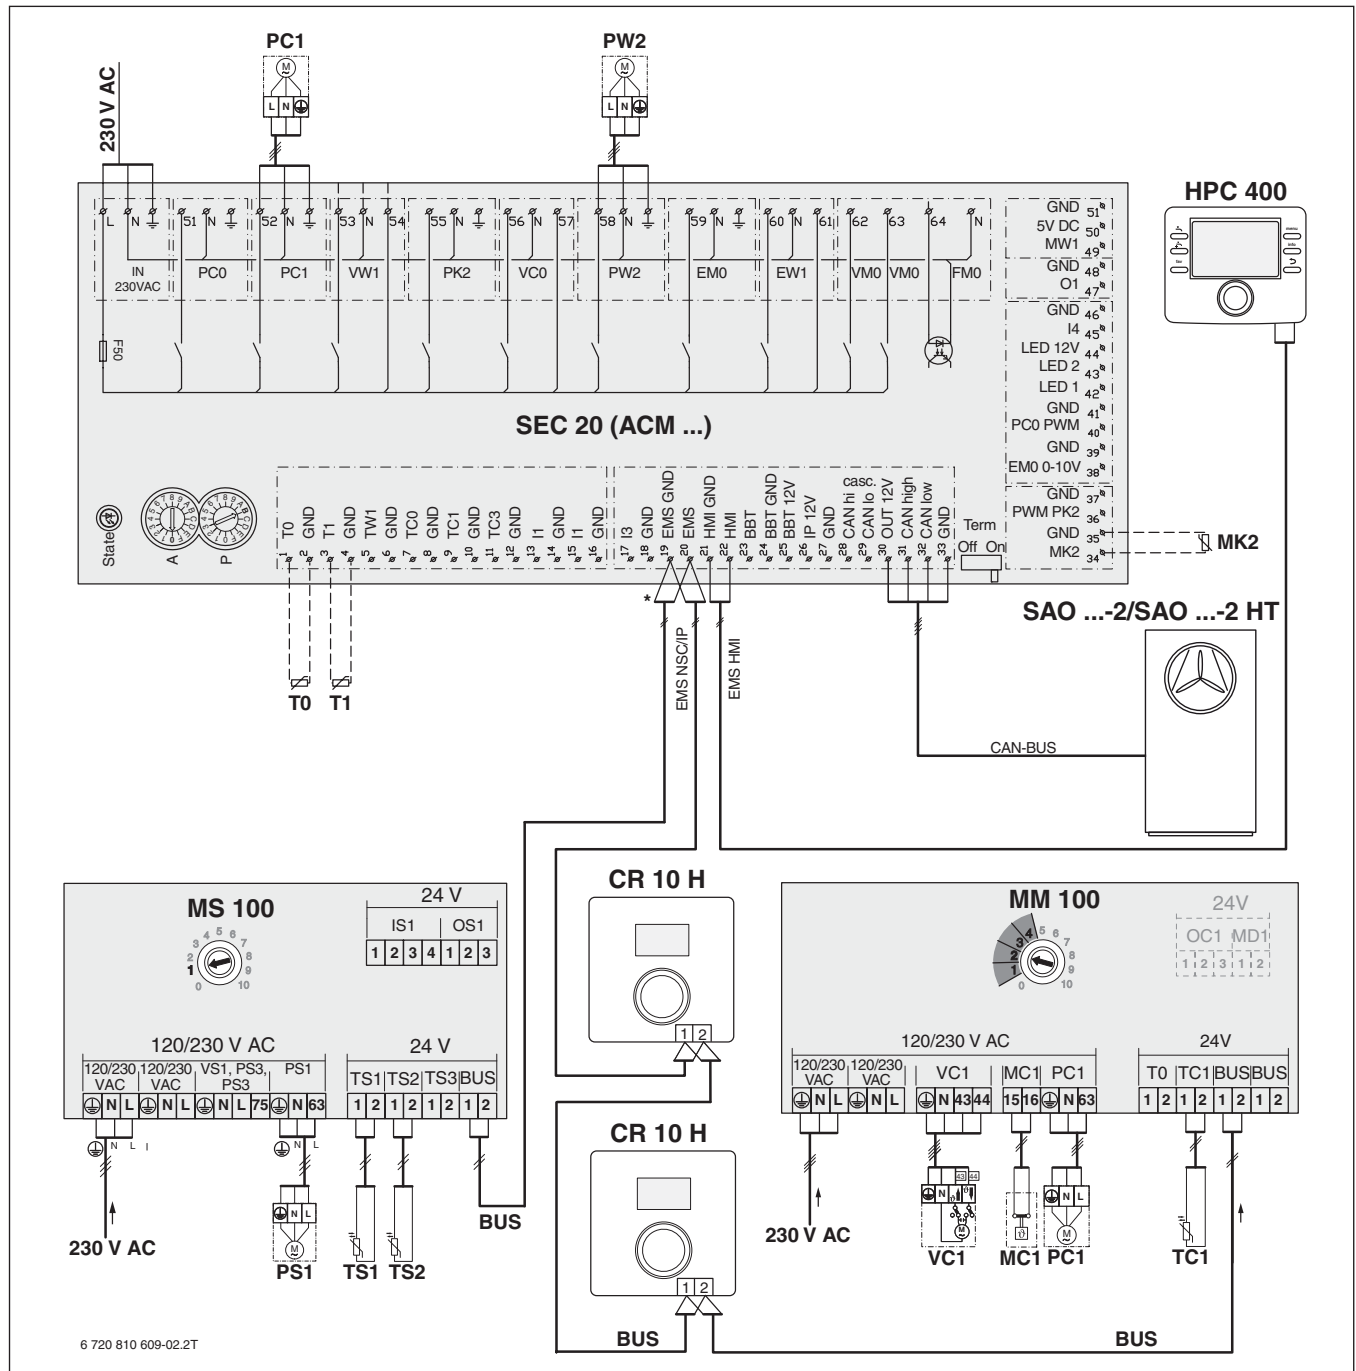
Schaltplan zum Anlagenschema (Legende → Bild 1)
